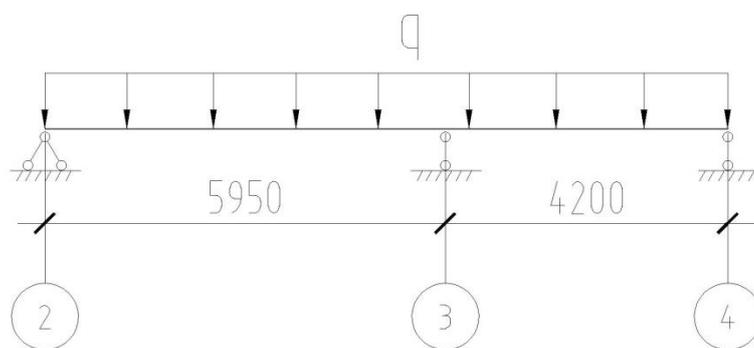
Расчётная схема монолитного участка перекрытия
